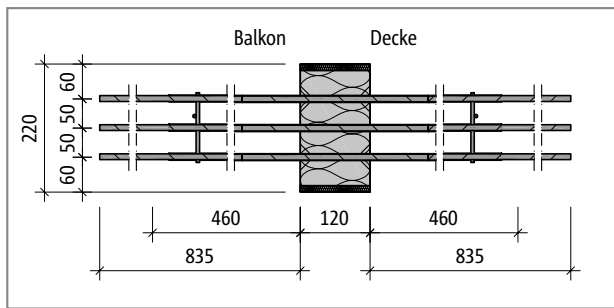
Schöck Isokorb® XT Typ B: Produktgrundriss
